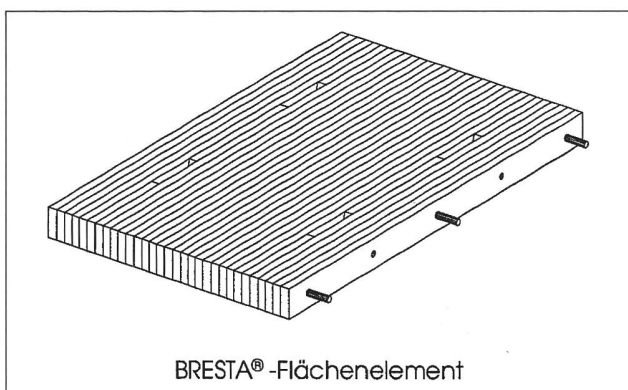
Gedübelte Brettstapelelemente, Tschopp Holzbau, Hochdorf.
